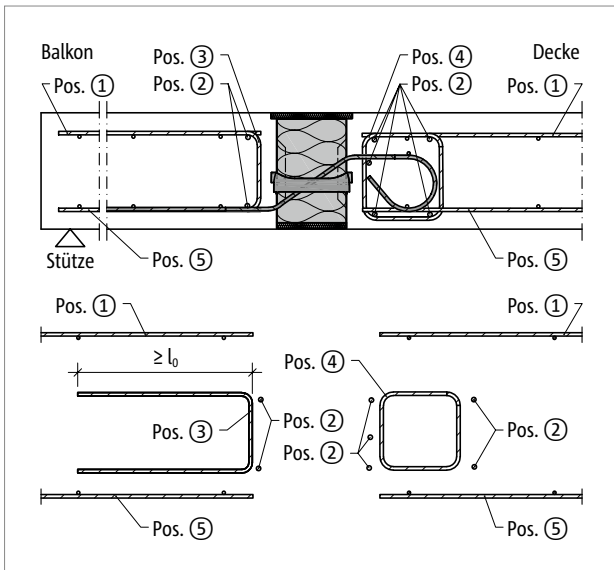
Schöck Isokorb® XT Typ QL-V1 bis V4 Bauseitige Bewehrung
